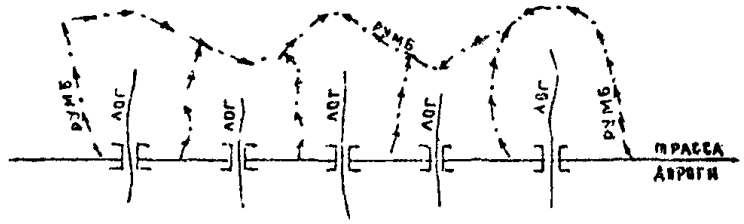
Схема водолитных ходов при хорошо выраженных водоразделах.
